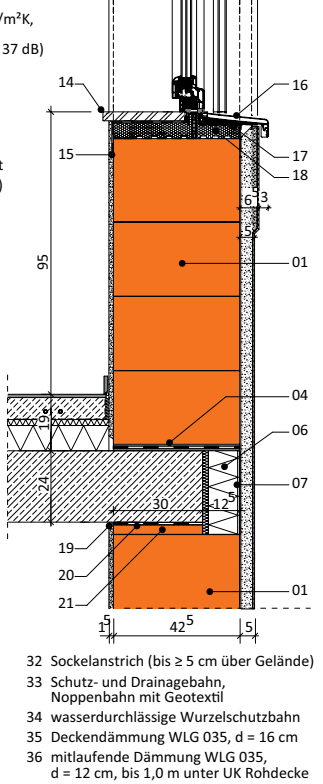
DETAIL DECKEN- UND FENSTERANSCHLÜSSE
